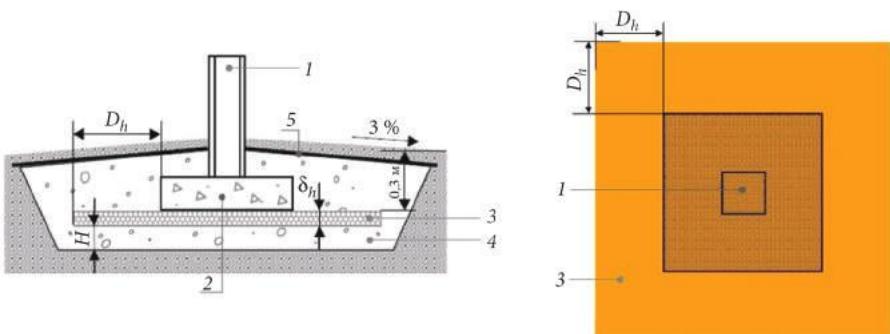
Схема укладки теплоизоляции в фундаментах отдельно стоящих опор: 1 — опора; 2 — фундамент; 3 — теплоизоляционный слой из XPS плит; 4 — песчано-гравийная смесь; 5 — водоупорный слой
